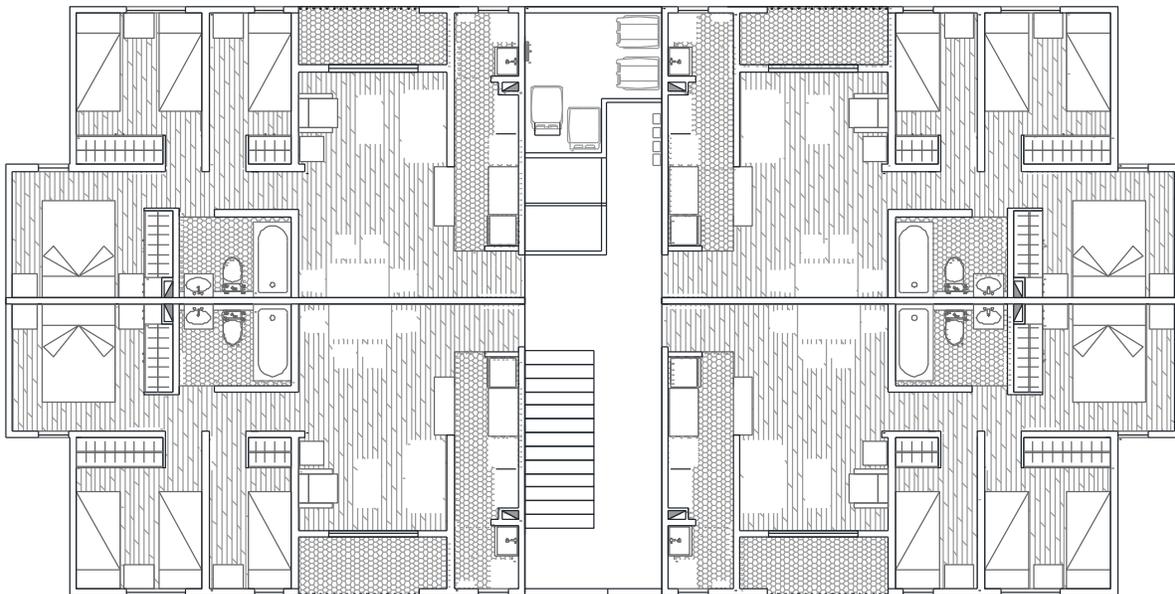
Vista en planta del edificio de cinco pisos, distribución de muros.
